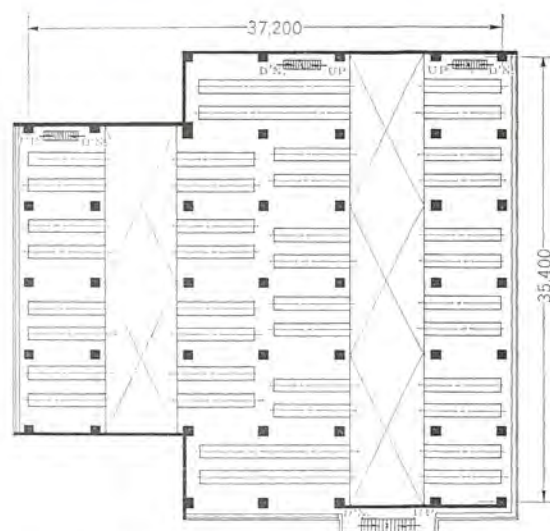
大阪市安土町駐車場一般階平面図 (トロッコ、エレベータ、ドーリ式)
